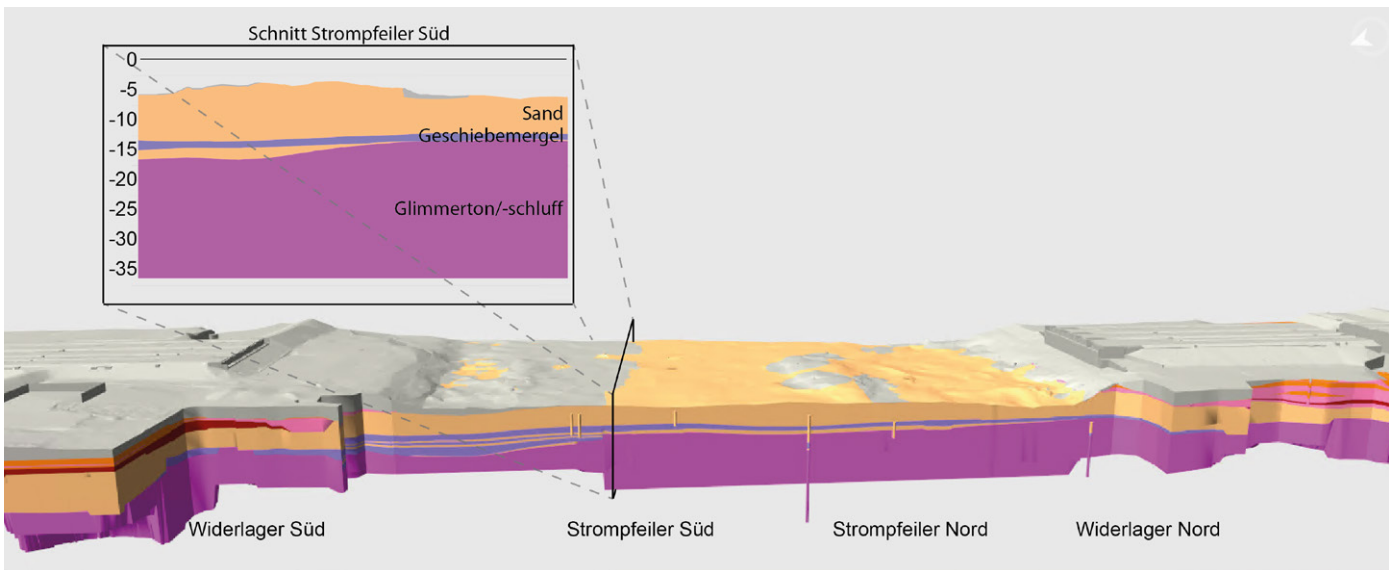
Fachmodell Baugrund mit Detailschnitt im Bereich des Strompfeilers Süd
